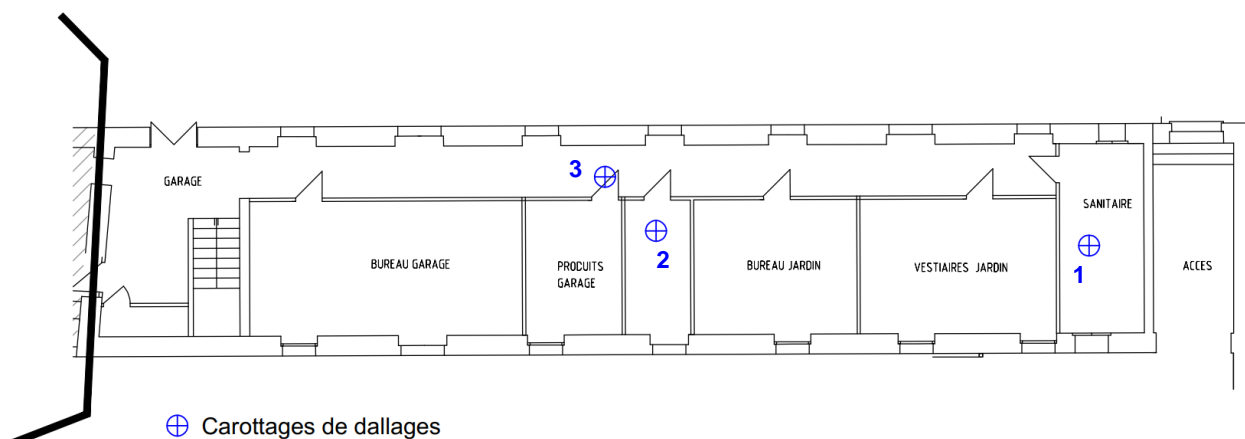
Implantation et repérage des carottages du dallage du plancher bas RDC
